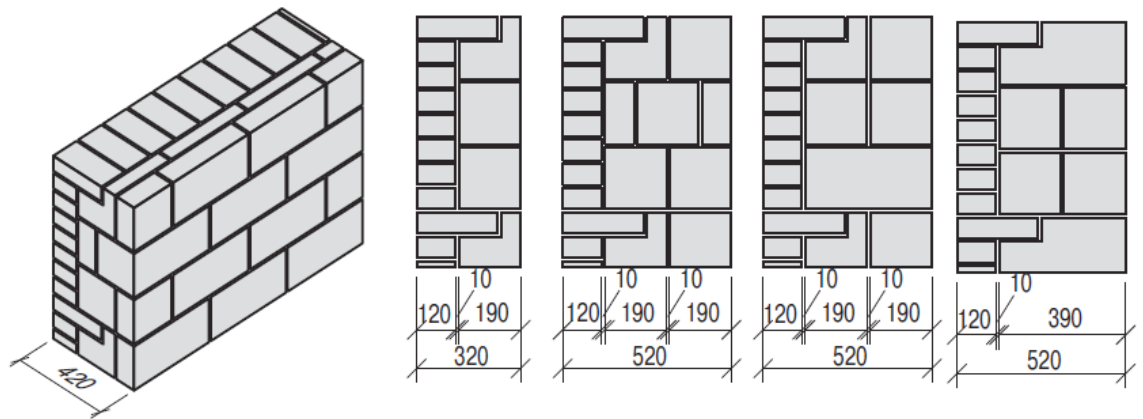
Кладка из бетонных камней (блоков) с четвертью с облицовкой кирпичом. 1951 г.
